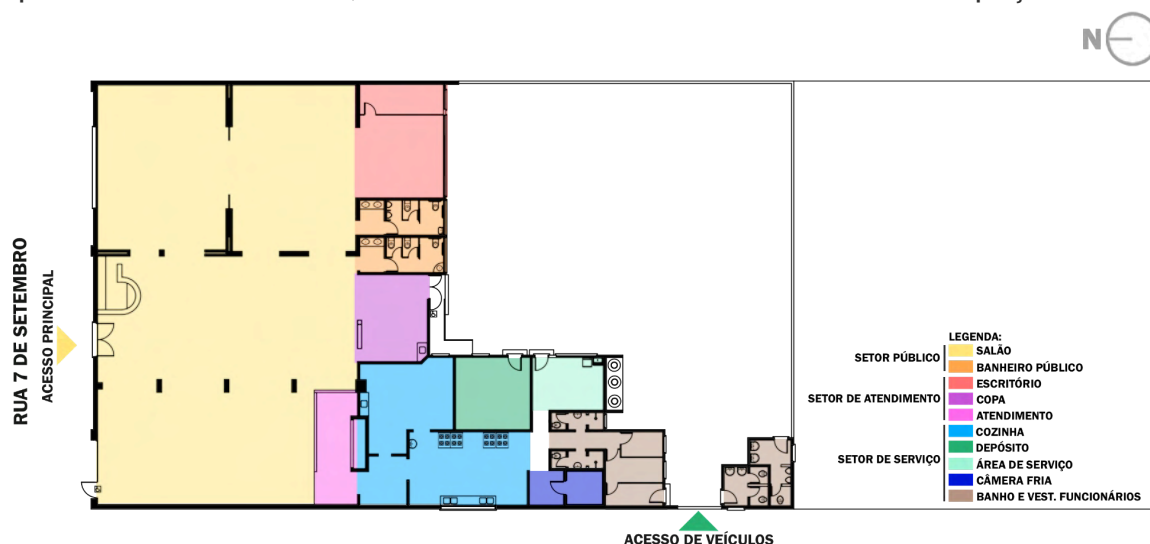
Análise de usos da planta baixa do restaurante Di Capri atualmente.
